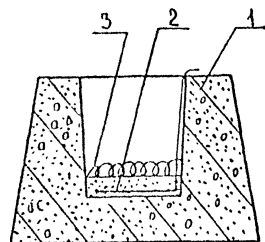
Обогрев подливки под колонну нагревательными проводами
